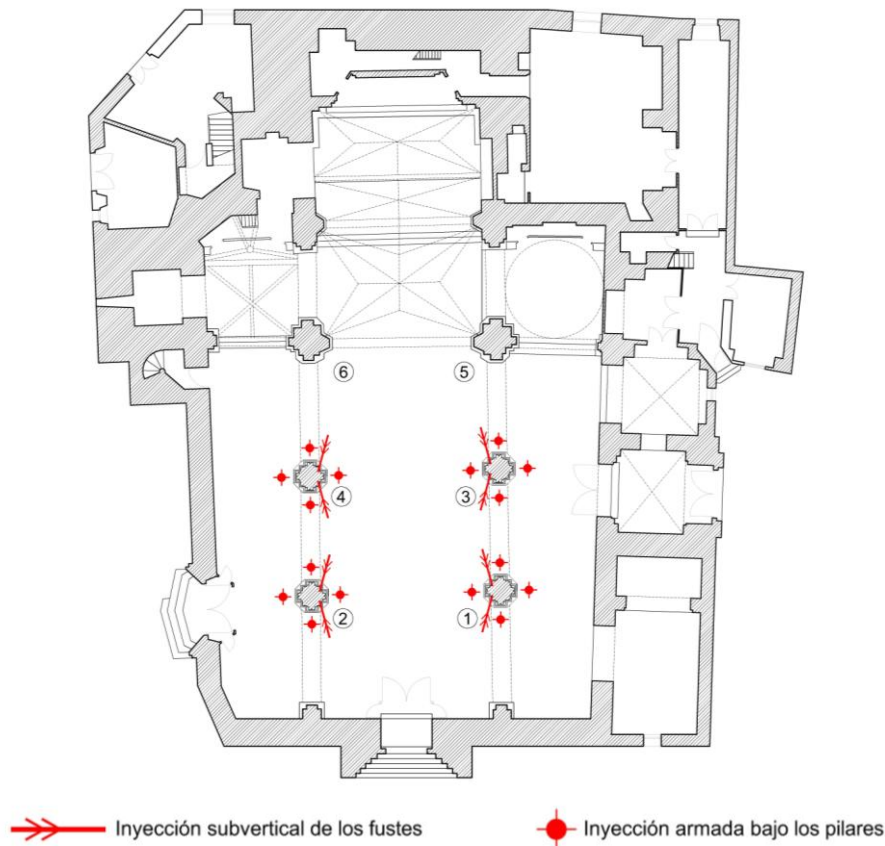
Esquema del tratamiento en planta de los pilares y la cimentación.
